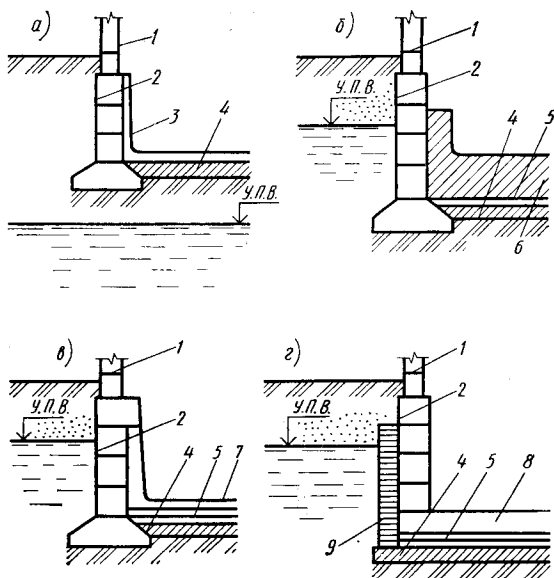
Устройство гидроизоляции подвальных помещений:
